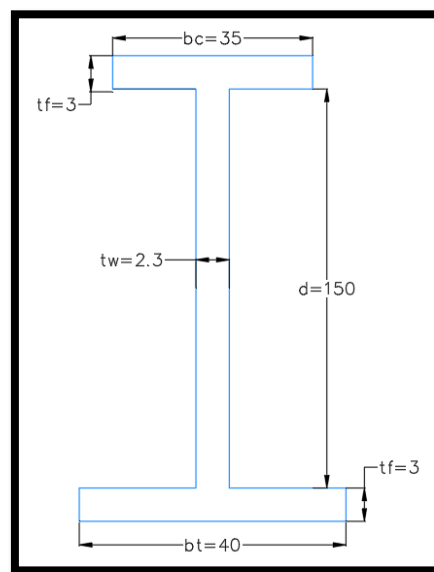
Dimensiones de las vigas. Fuente: (Autor).
